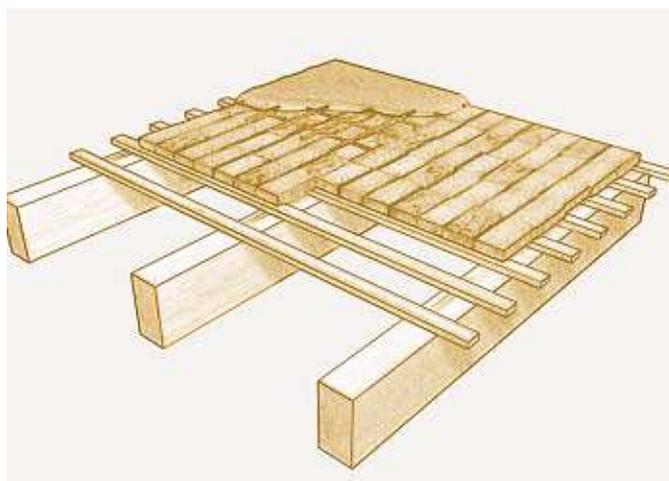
Forjado tradicional de las viviendas pertenecientes a la tipología 2
